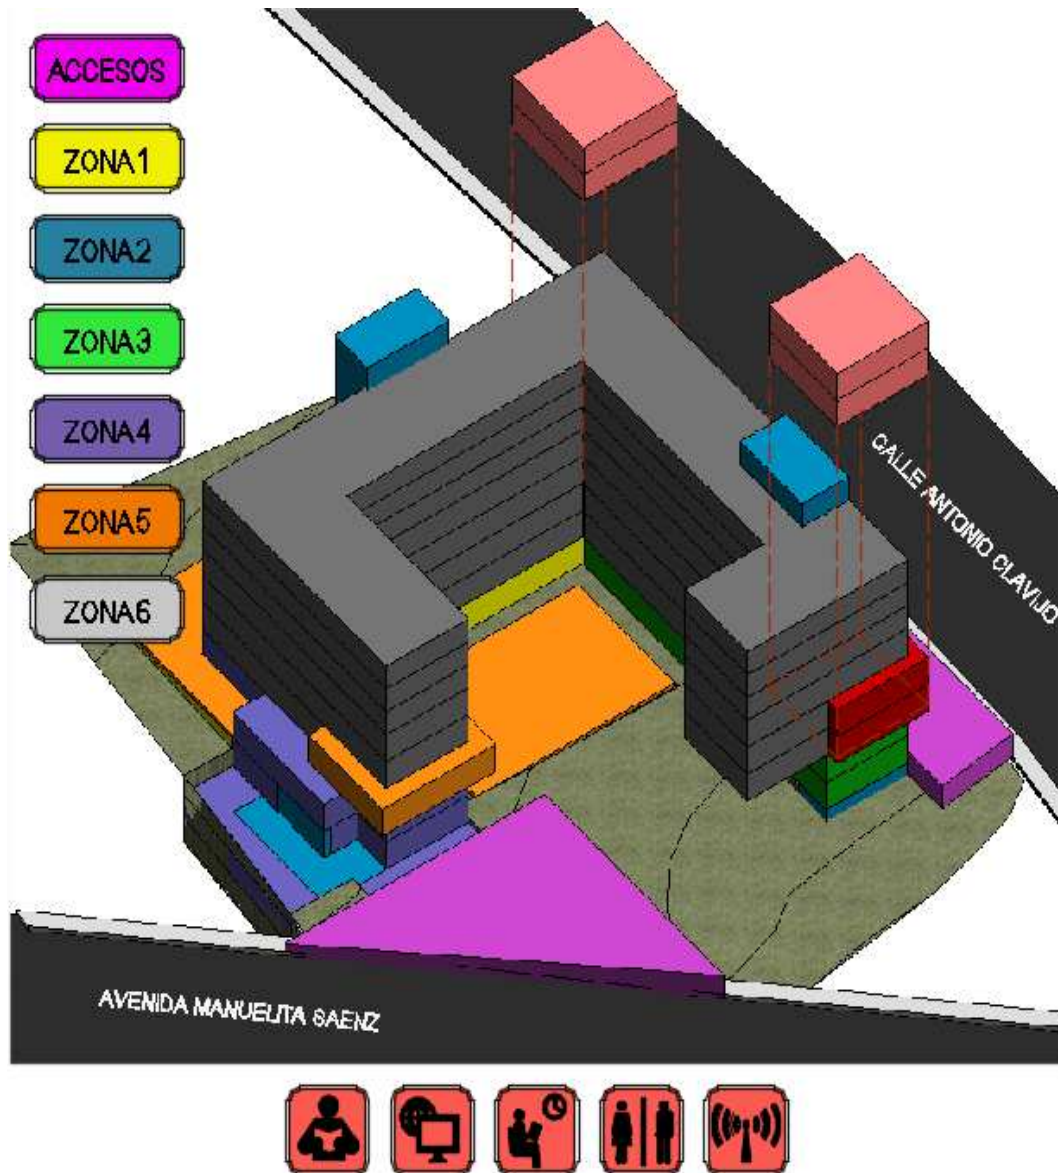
Plan Masa. Zona 6. Dormitorios
